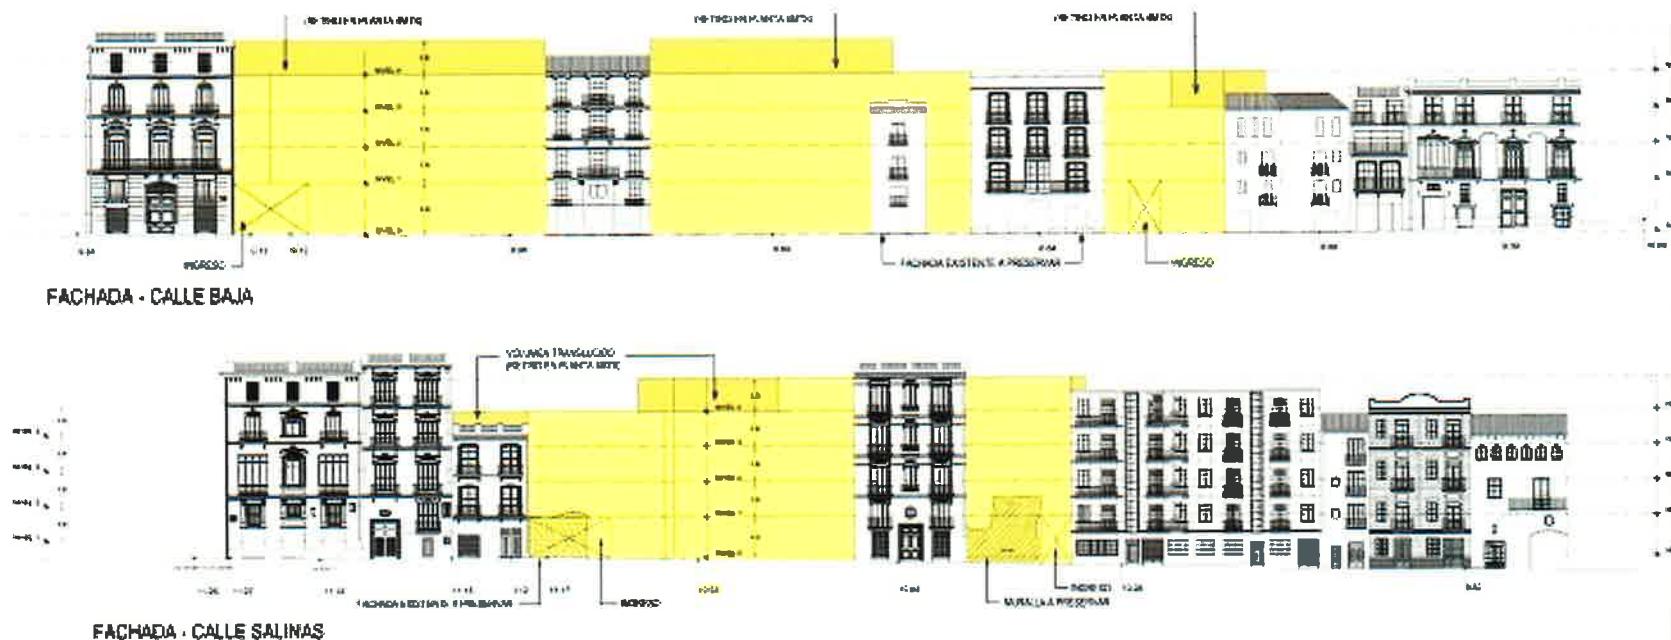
| ESTUDIO DE ALTURAS EN LAS FACHADAS DE LAS CALLES BAJA Y SALINAS.
